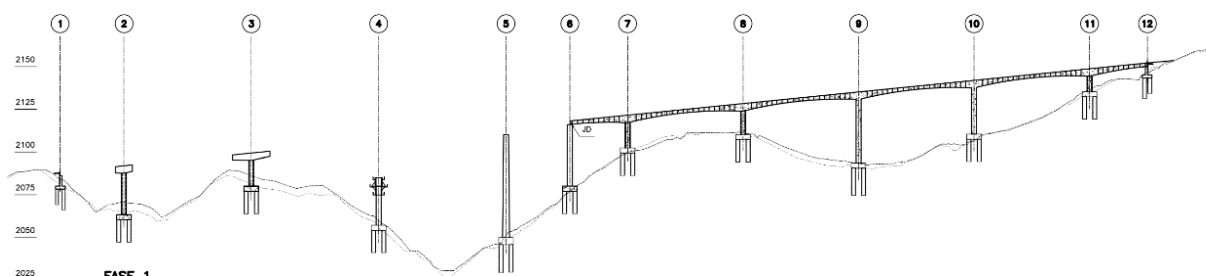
Alzado desarrollado del puente con el estado de la construcción en la paralización.
